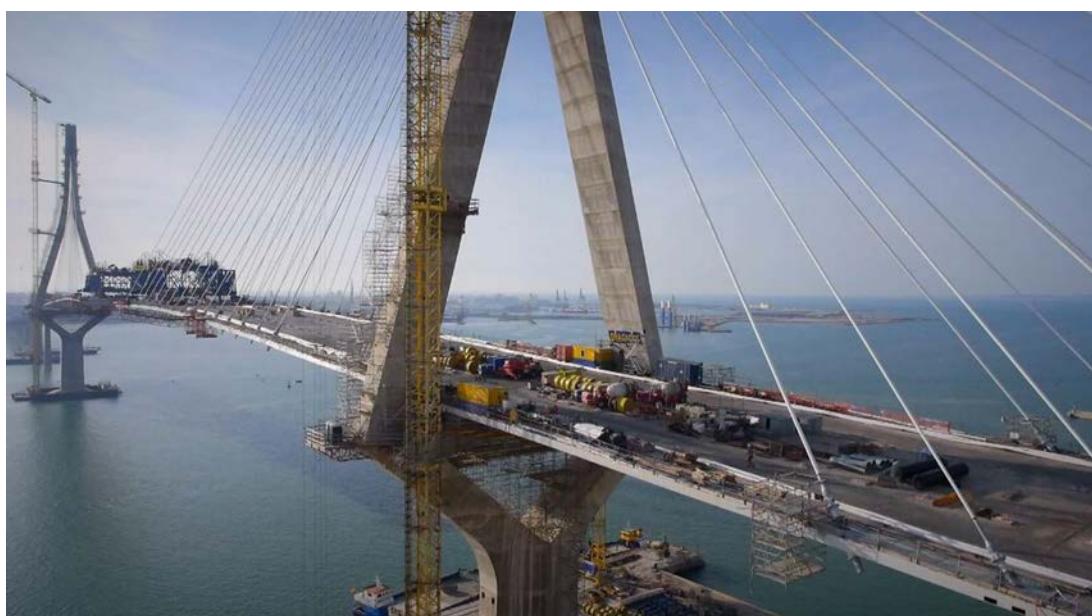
Ubicación de las cargas sobre el tablero durante el proceso de construcción.
